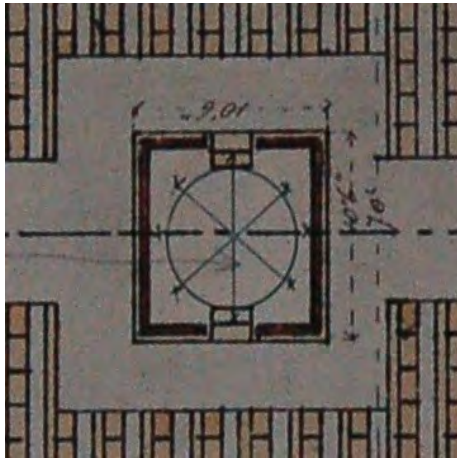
Planmaterial Grundriss Ausschnitt mit eingezeichneter Estrade
